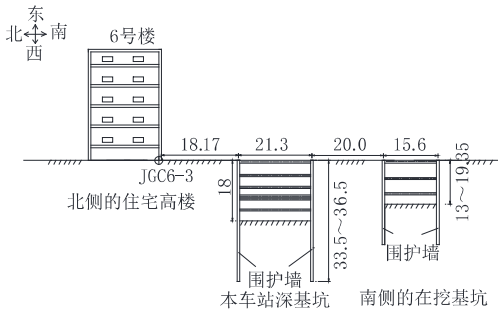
基坑标准段 19-22 轴剖面示意图(单位:m)
